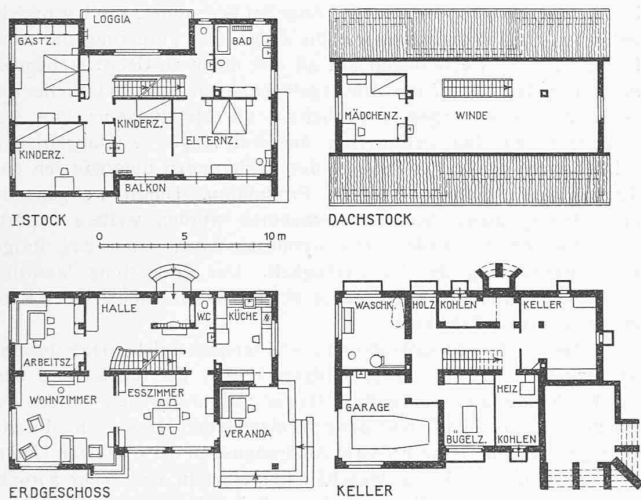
Haus Stiefel. Arch. Albert Kölla, Wädenswil. — Grundrisse 1 : 400.
